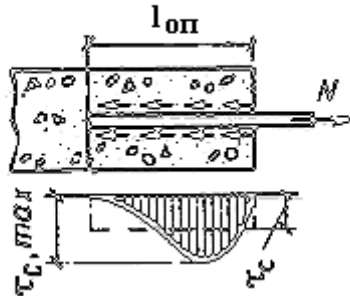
Напружений стан арматури і бетону при витягуванні арматури
